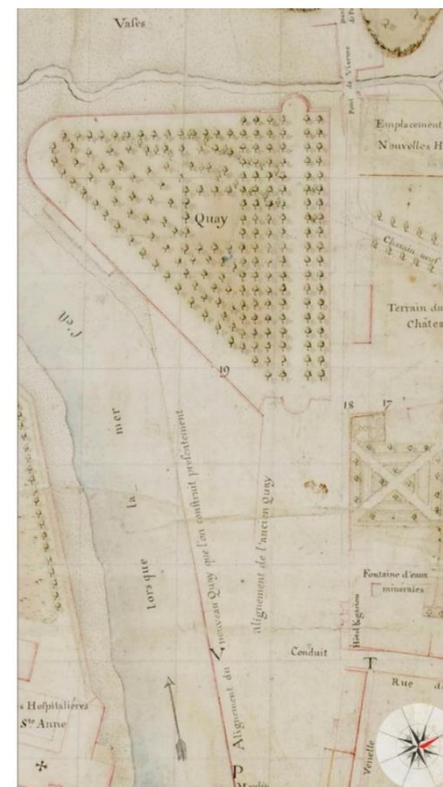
Vue en plan du nouveau quai et de la nouvelle rue du Pavé Neuf en 1763 (AD22, C13, Plan Anfray, 1763)
